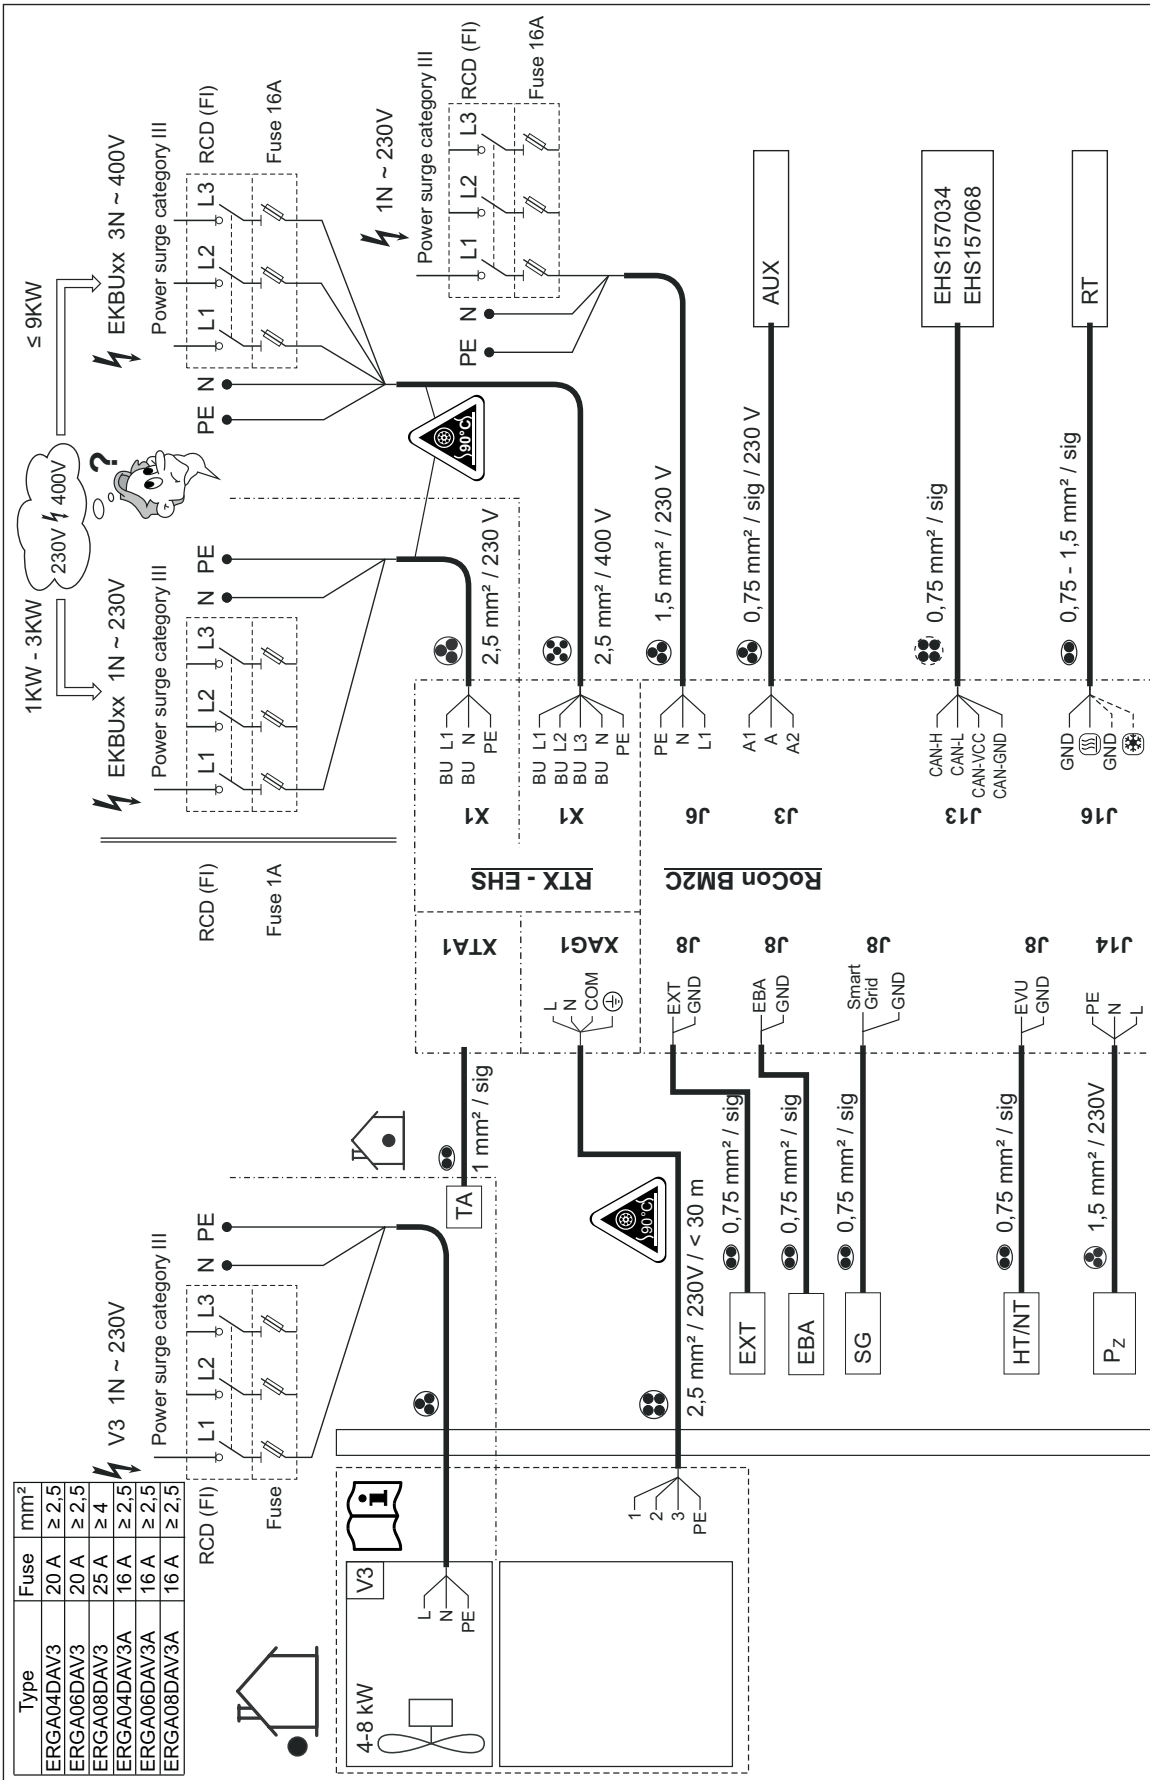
Gesamtanschlussplan - für den elektrischen Anschluss bei der Geräteinstallation (Legende und Anschlussbelegung der Schaltplatte siehe Kap. 10.5)
